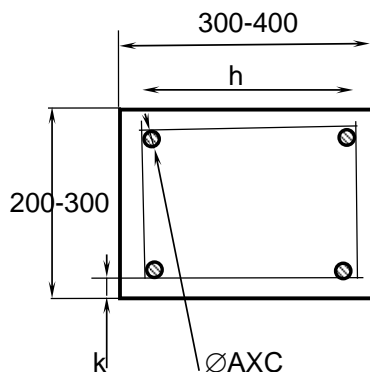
Геометричні параметри та схема армування перерізу фрагмента залізобетонної балки-зразка для випробувань
